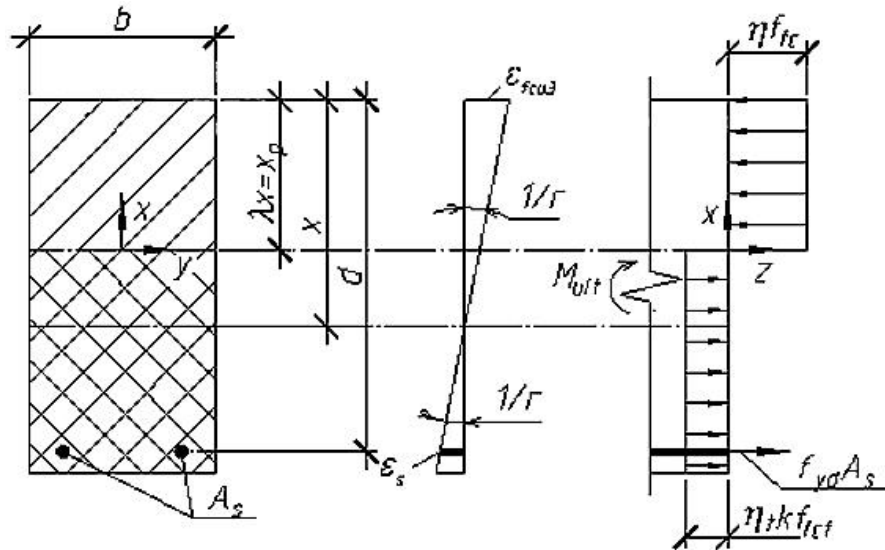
Схема зусиль та епюри напружень у перерізі, нормальному до поздовжньої осі згинального фібробетонного елемента прямокутного перерізу з поздовжнім армуванням при розрахунку його за міцністю
